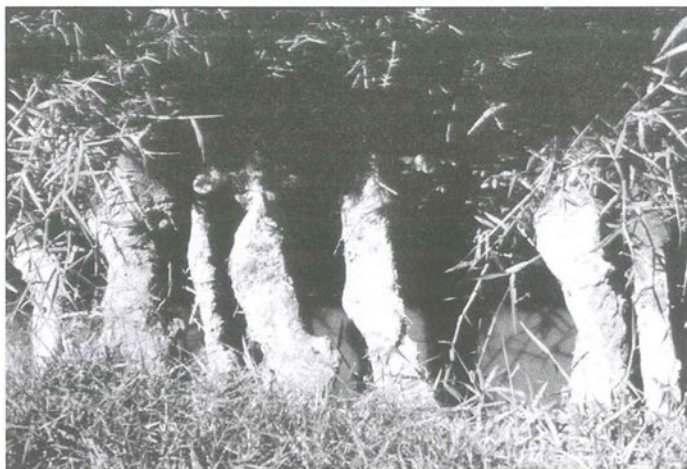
Dinteles de madera de la sección de la galería y zanjas rellenas del puquio Pampón. En este caso, el relleno sobre la galería ha sido arrasado o se ha caído dentro, exponiendo los dinteles de madera.
